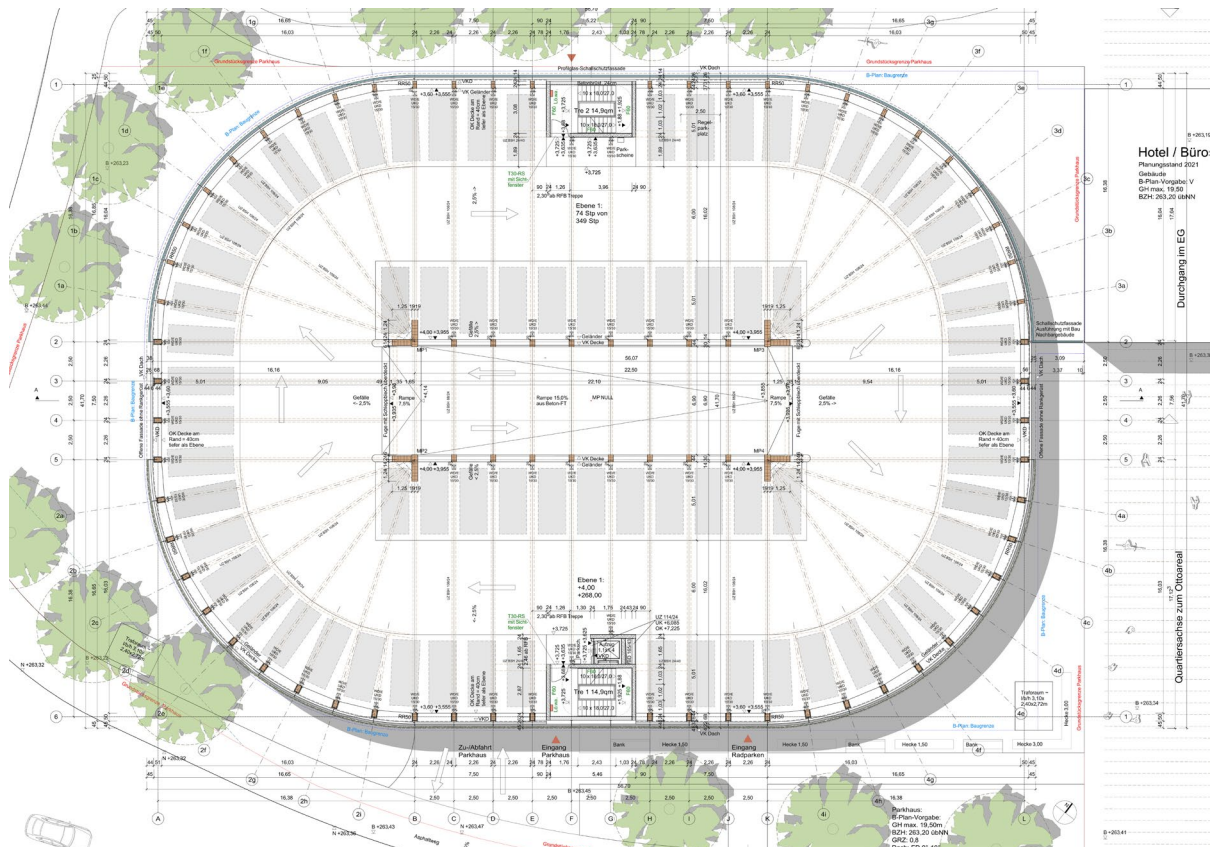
Grundriss Parkhaus © herrmann+bosch Architekten
